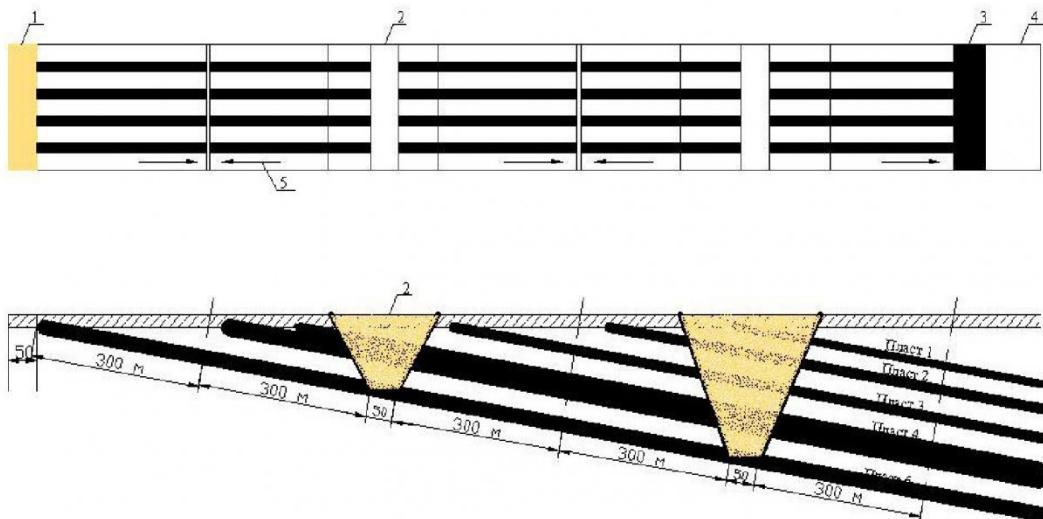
Схема отработки пластов угля КГРП вскрытыми траншеями:
